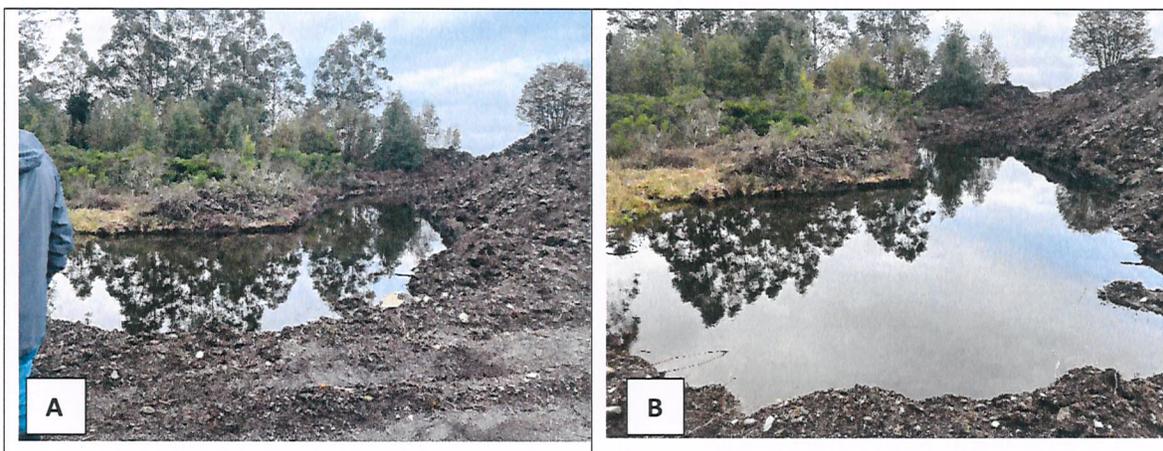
A) Tubería que conduce aguas lluvias en sector del Humedal Valle Volcanes (sector lote 3-b-1) . Fotografía 4: B) Vista general del sector intervenido por la empresa (sector Lote 3-b-
